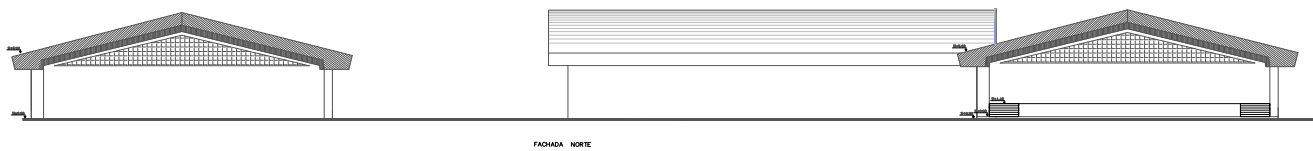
Fachada norte existente de la plaza “Mercado de los Plátanos”
